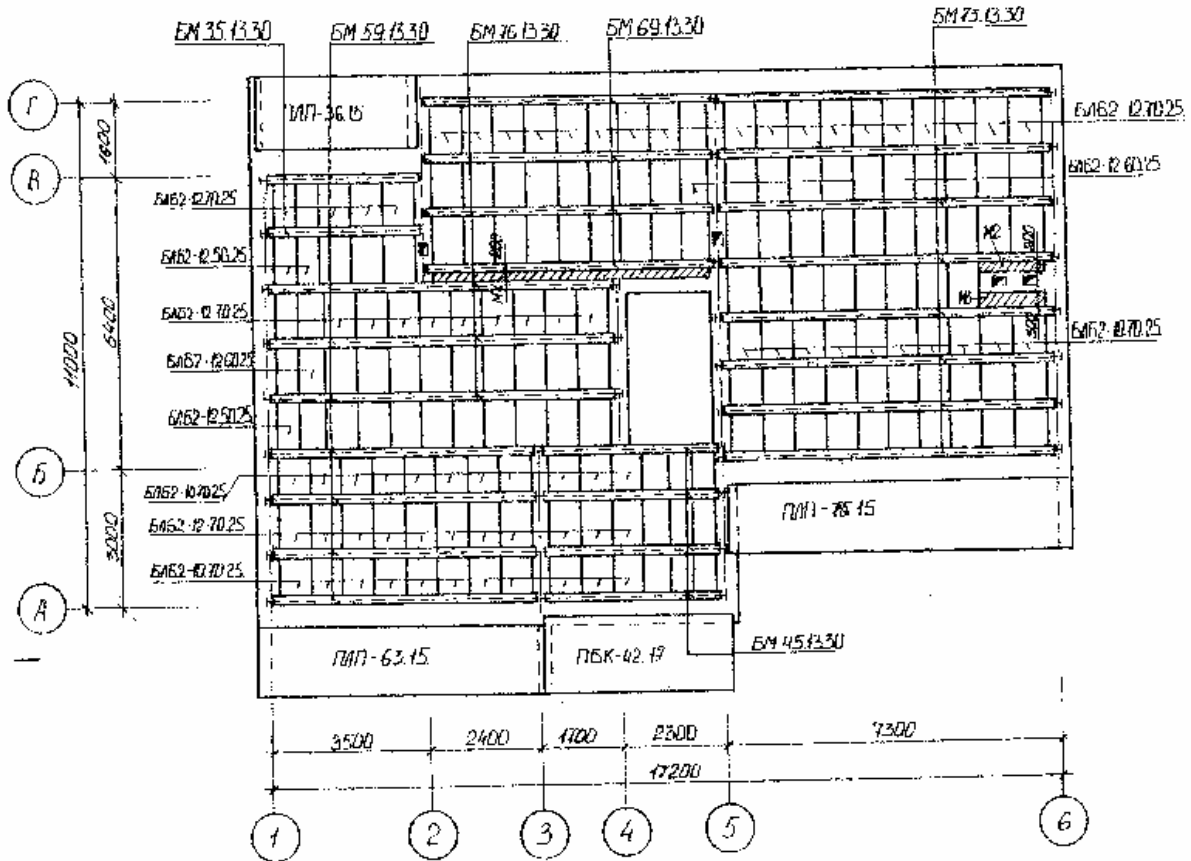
Пример оформления плана перекрытий из мелкогабаритных элементов
